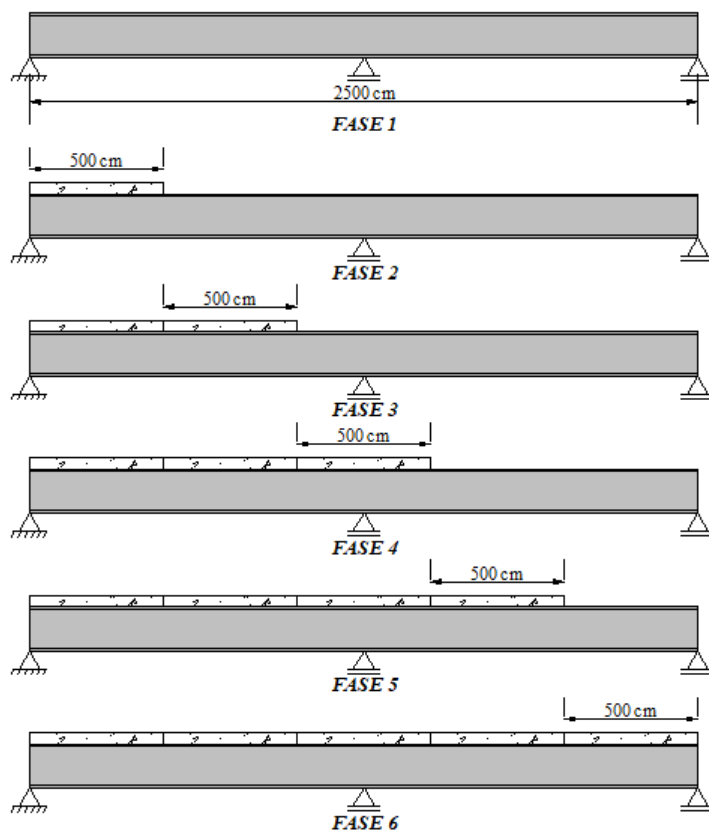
Processo executivo alternado da viga mista contínua – Exemplo B1.
